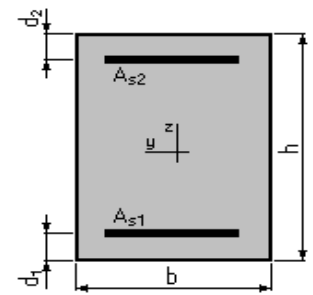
Ferrailage de la dalle dans les sens X et Y.
